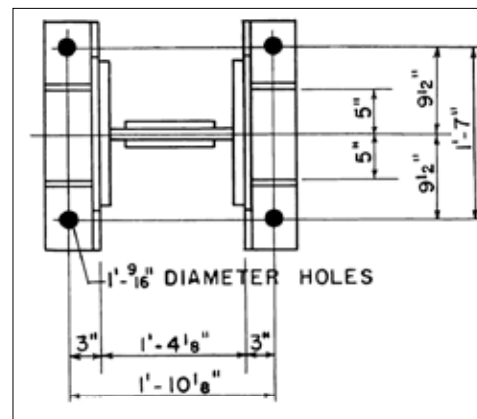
Anclaje entre la base del pilar y la placa soldada (Nota 47)
